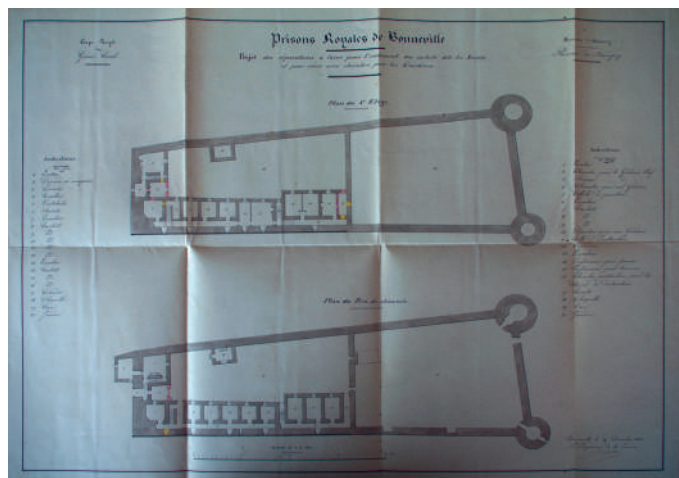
Plans de 1856. Archives Départementales de la Haute-Savoie (fonds 5FS43).
